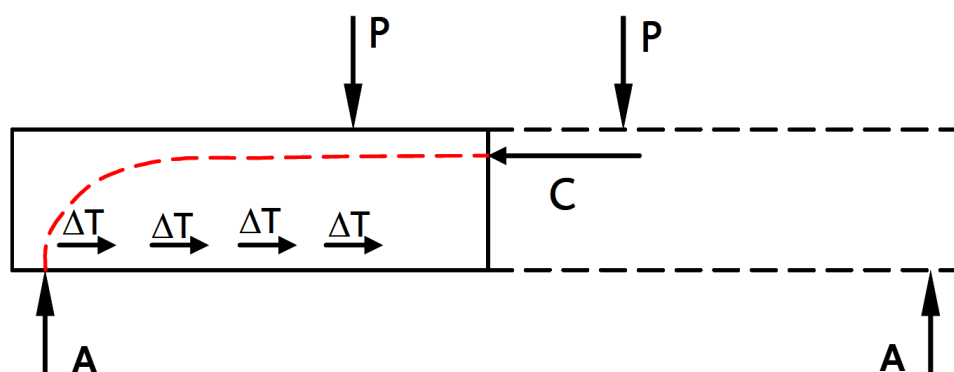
Esfuerzos internos en una viga con armadura longitudinal adherida.
